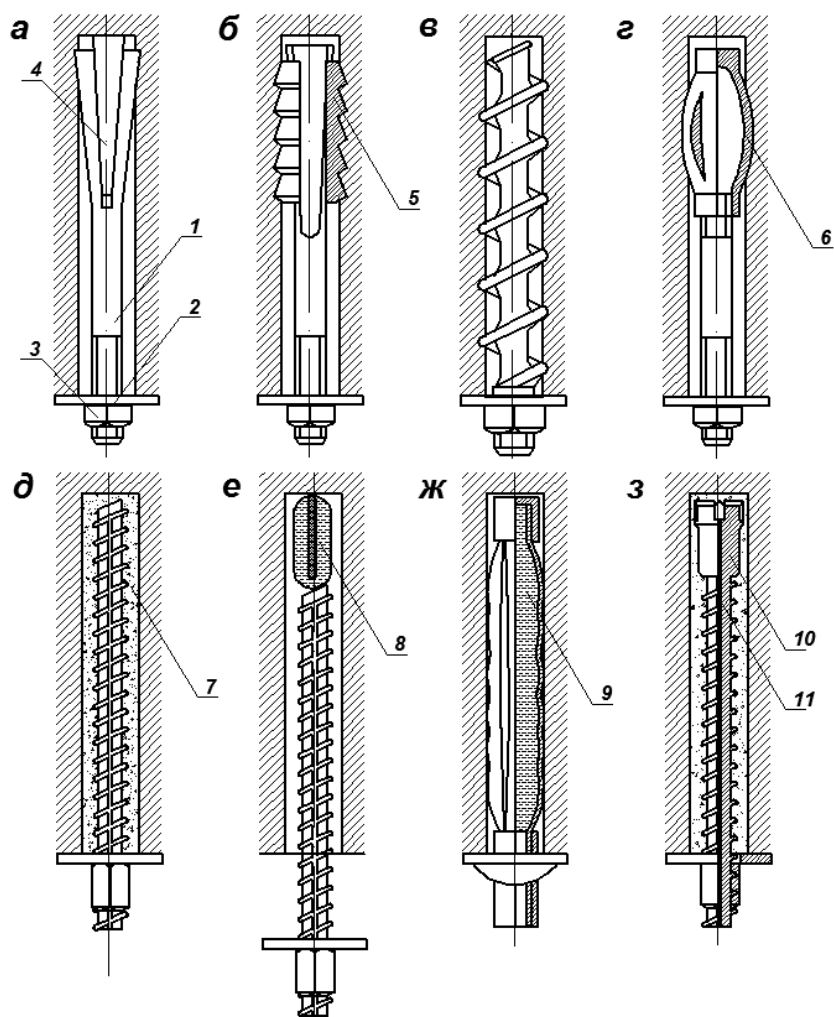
Конструкции анкеров: *а* - клинощелевой; *б* - распорный; *в* - винтовой; *г* - взрывораспорный; *д* - сплошной железобетонный; *е* - сталеполимерный; *ж* - анкер Swellex; *з* - самозабуривающийся анкер SDA; 1- анкер; 2 - опорная шайба; 3 - гайка; 4 - клин; 5 - клиновидный сегмент; 6 - трубчатая головка после взрыва низкобризантного ВВ; 7- песчано-цементная смесь; 8 - ампула со смолой и отвердителем; 9- вода; 10 - интегральная коронка; 11- отверстие в анкере для подачи песчано-цементной смеси.
